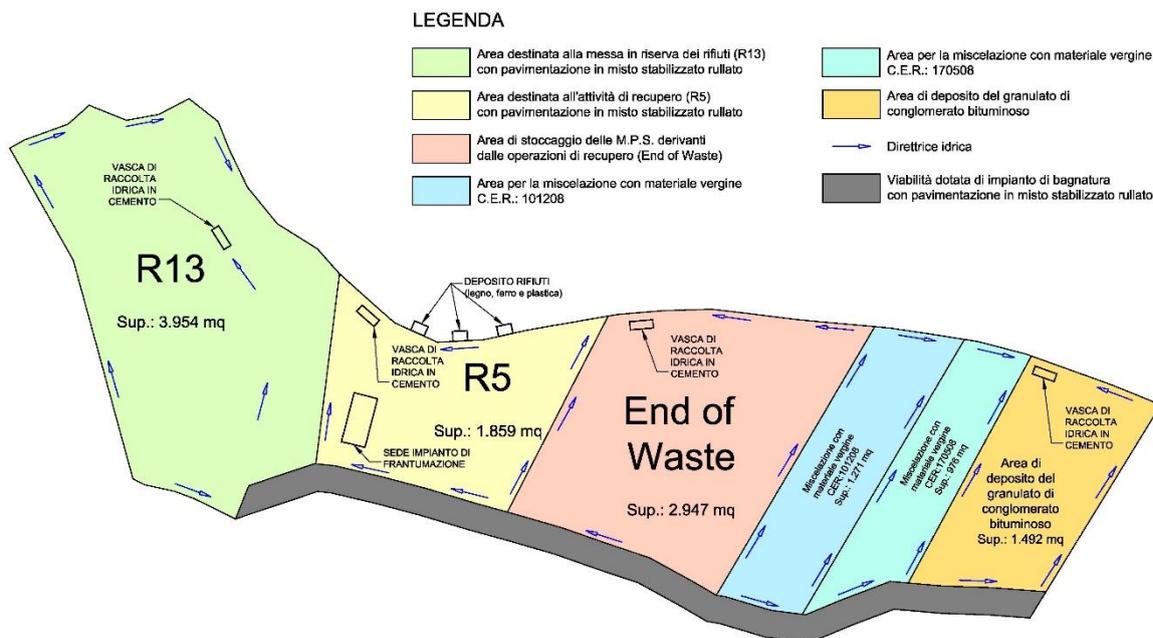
Schema planimetrico dell'impianto per la gestione di rifiuti da costruzione e demolizione in progetto
